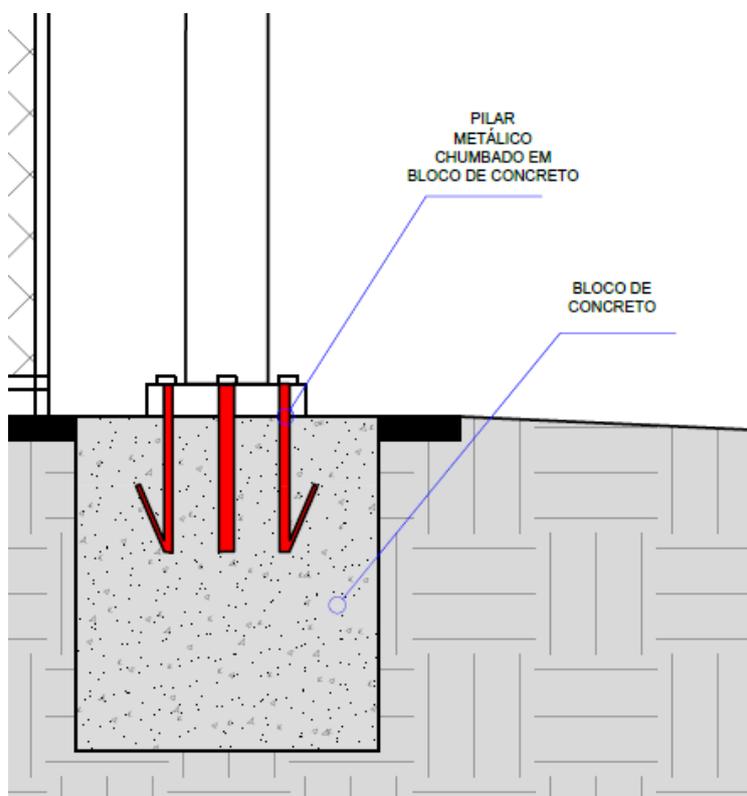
FIXAÇÃO DOS PILARES EXISTENTES
